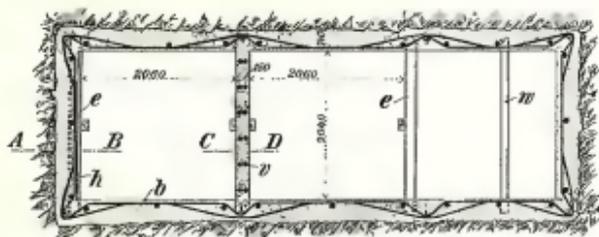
Eisenbetonausbau eines rechteckigen Schachtes als Ersatz für Holzausbau.
